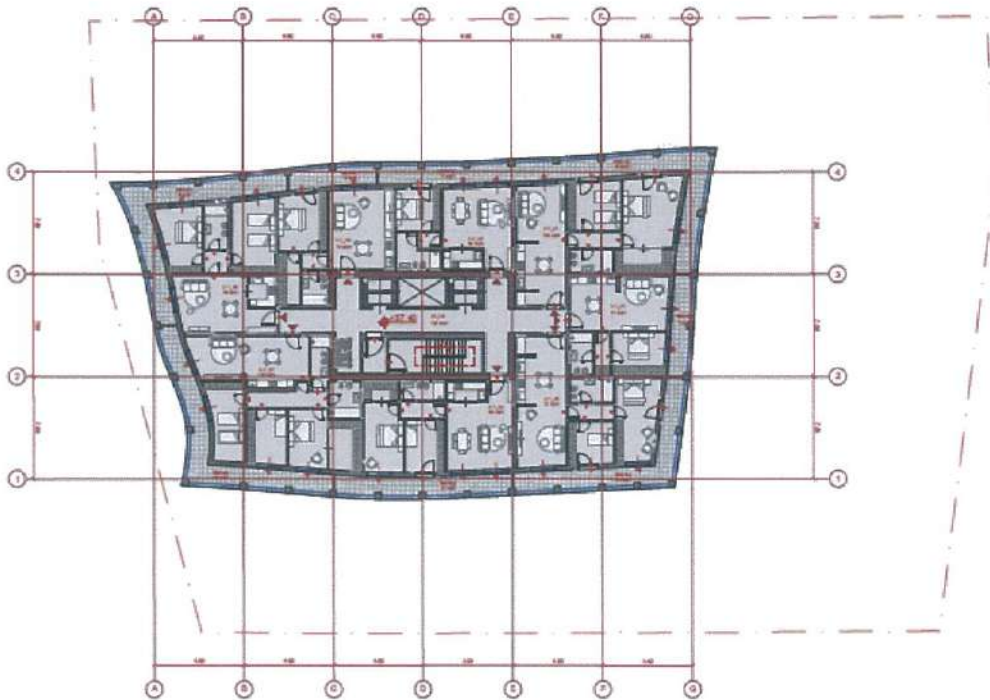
Planimetria e katit 9, në kuotën +37.40 SIP 1025 m²
